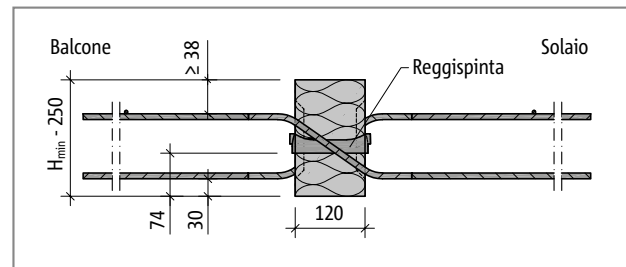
Schöck Isokorb® tipo da QXT70+QXT70 a QXT90+QXT90: sezione dell'elemento
